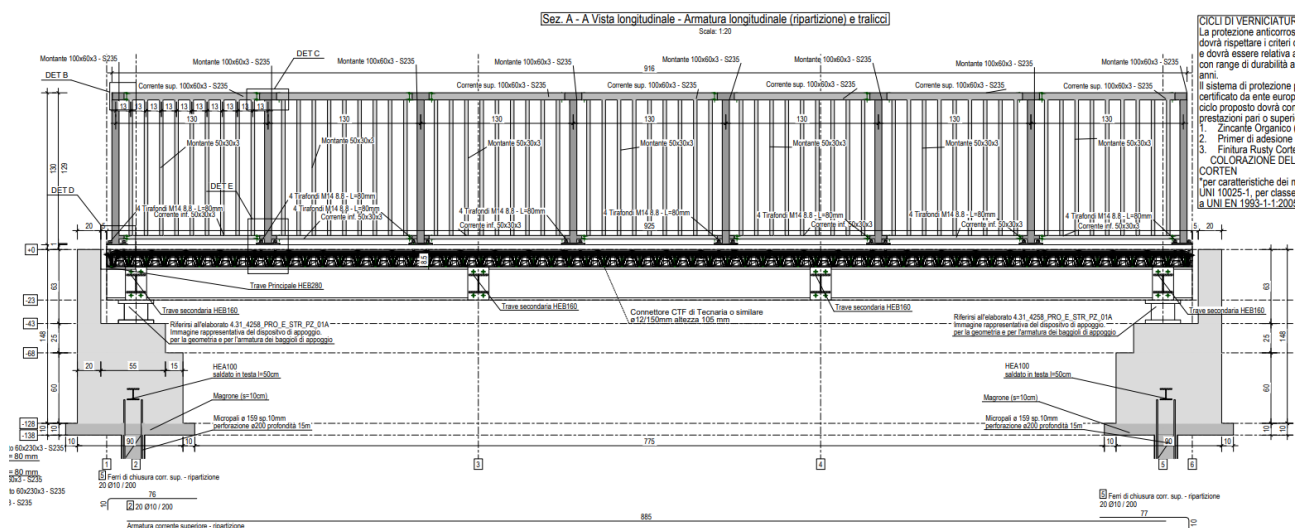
Vista longitudinale impalcato – Ponte pedonale 2B
